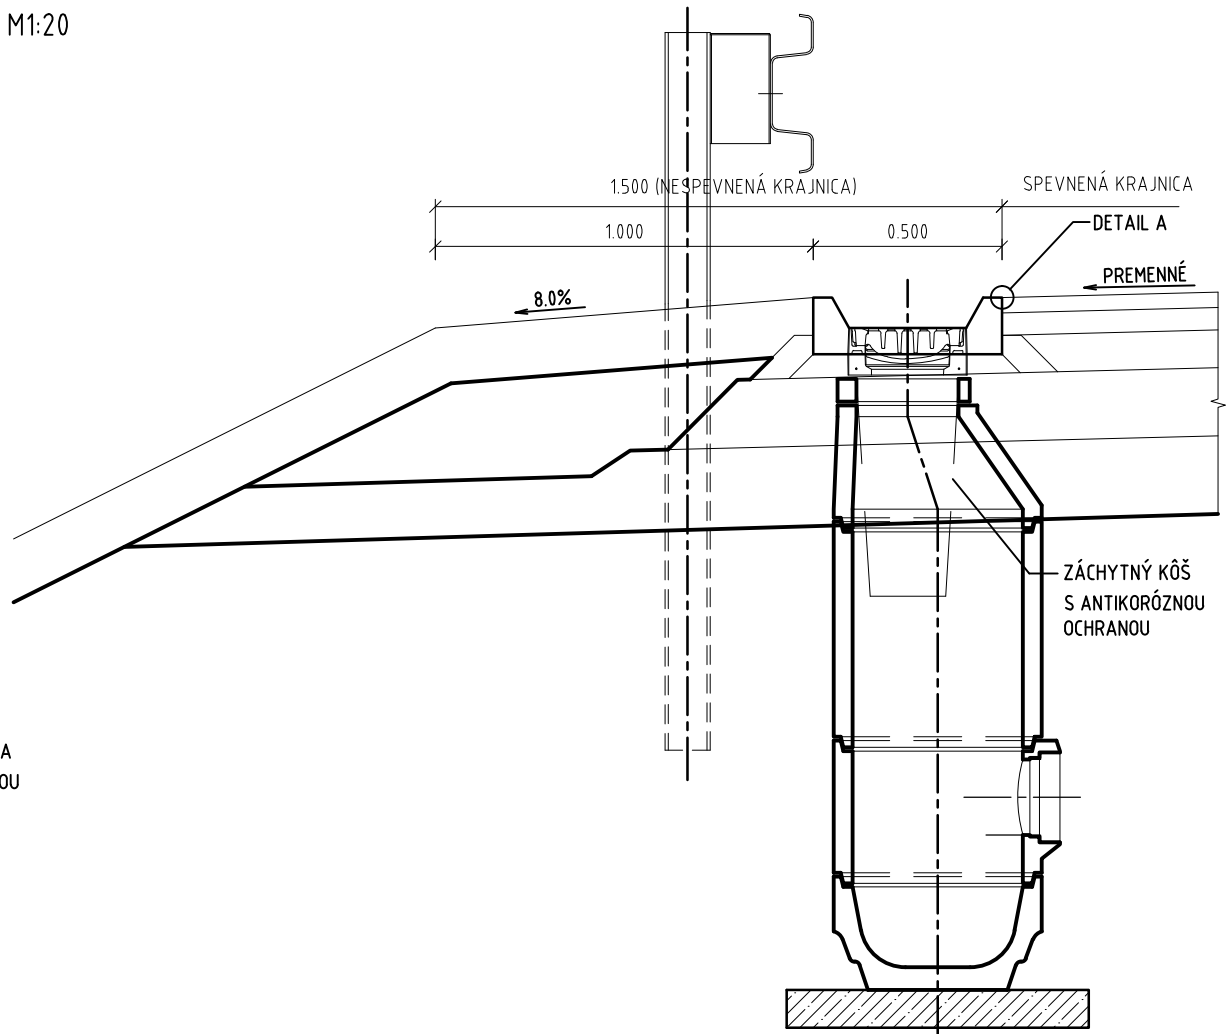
DETAIL OSADENIA PREFABRIKOVANÉHO ŽĽABU š. 0.50m V NESPEVNENEJ
